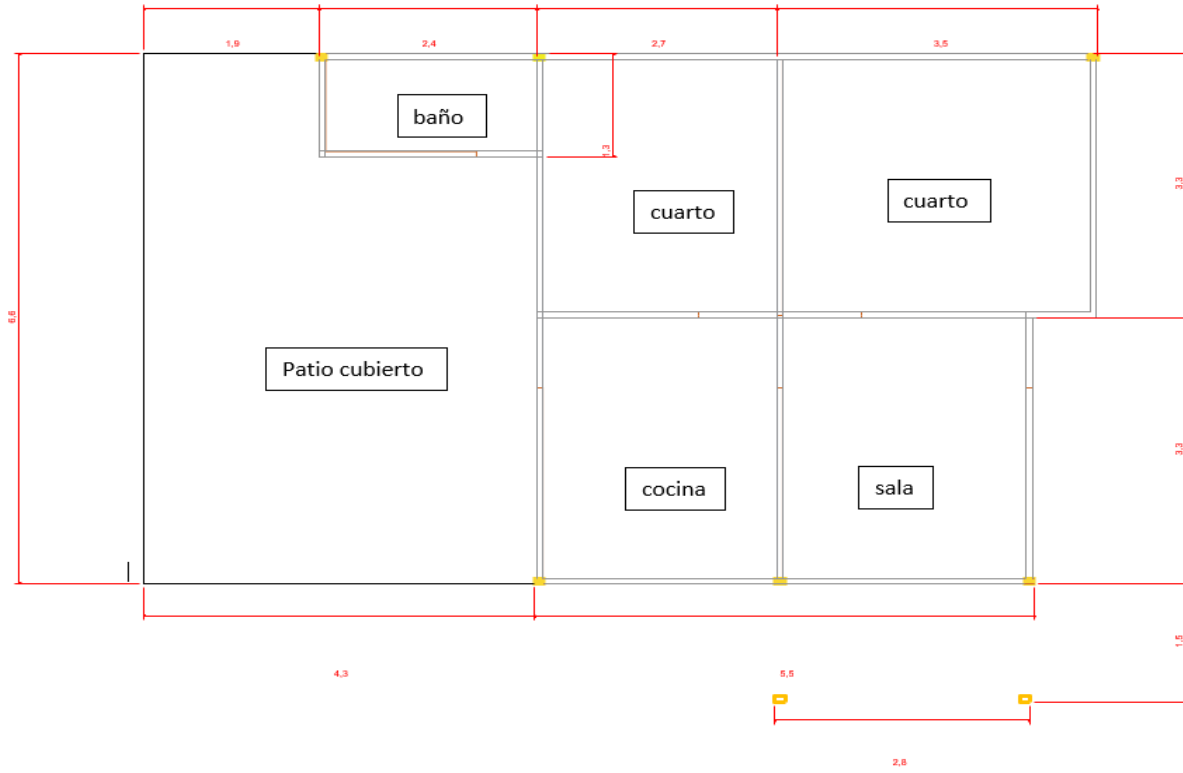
Distribución de vigas aéreas en concreto de la primera planta
